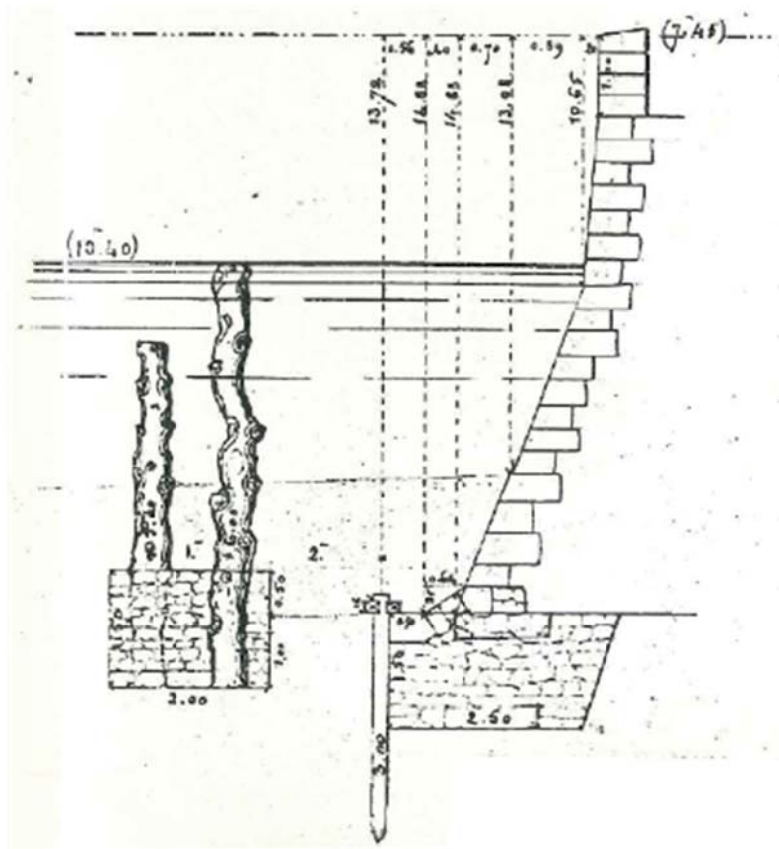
COUPE DE LA CHAUSSEE DU SILLON
